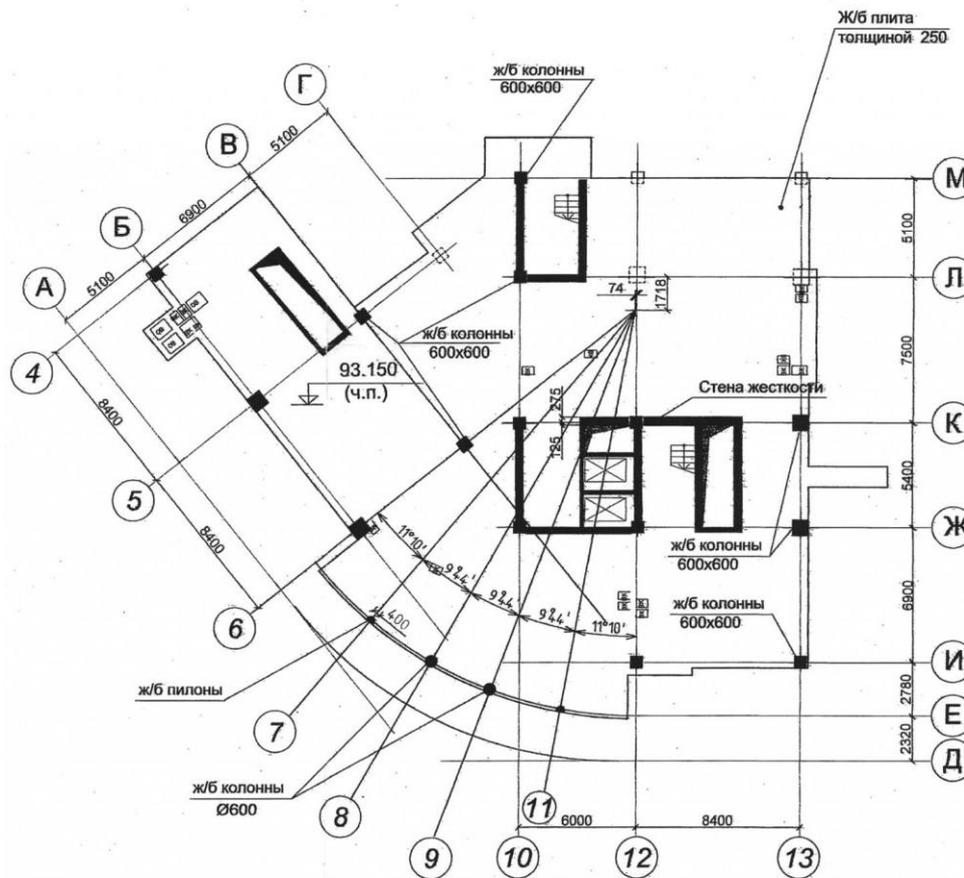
План конструкций 27 этажа на отм. 93.150 (ч.п.) высотного здания
